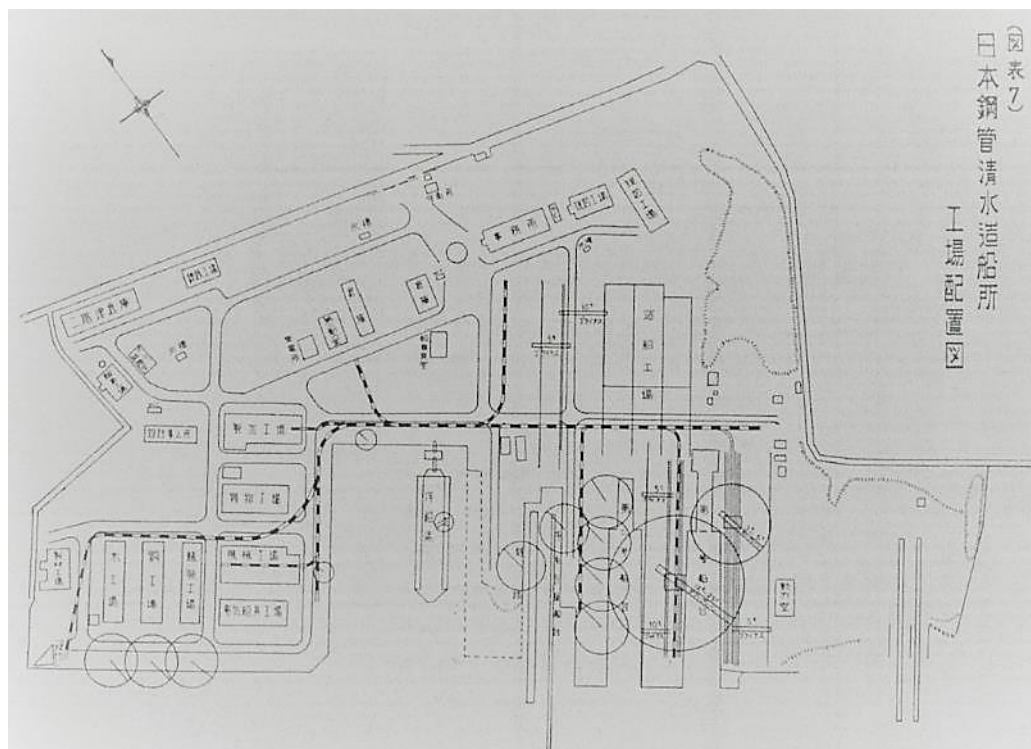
日本鋼管清水工場配置図 [412, p. 805]
